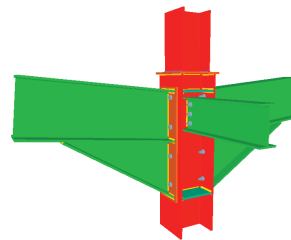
Unione bullonata di pilastro con due travi incastrate con fazzoletti d'angolo mediante lamiere frontali, e con una trave ortogonale incernierata mediante lamiera laterale (in corrispondenza della transizione dei pilastri)
